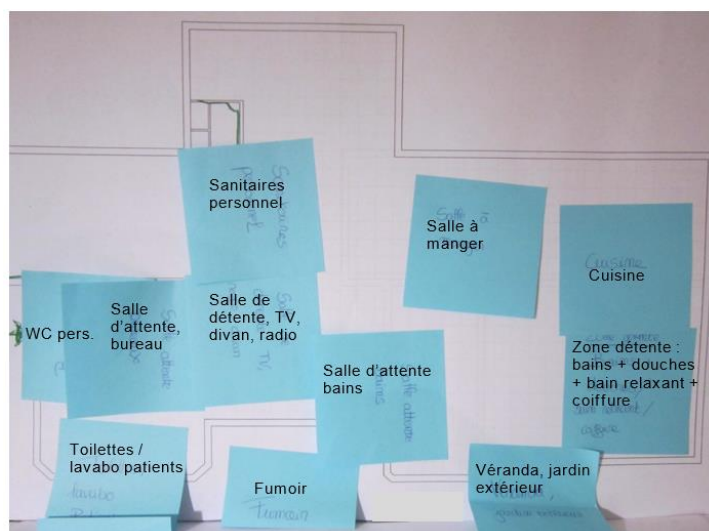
Zonage réalisé avec post-it sur fond de plan par G
